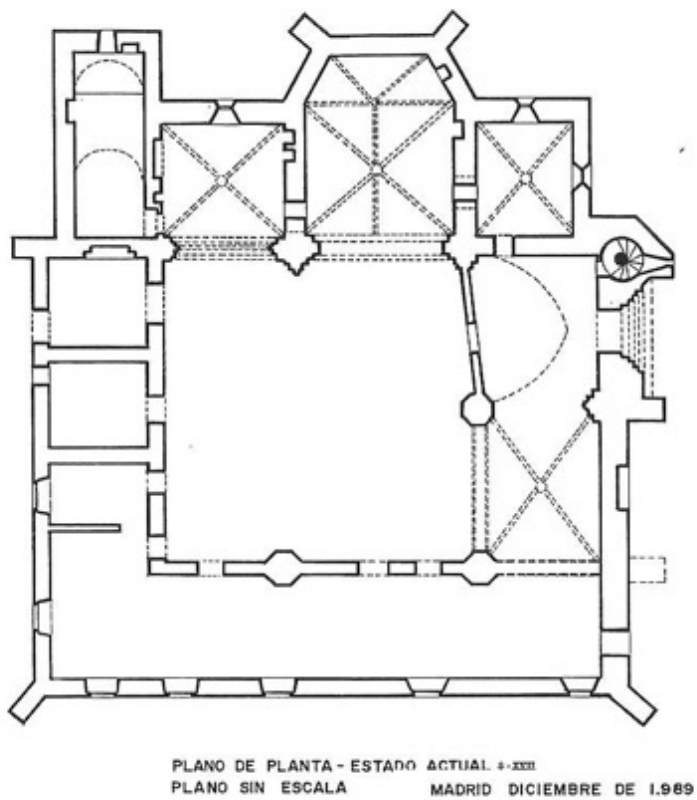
Bonaval, Santa María, Grundriss, Francisco Serrano Jurado, 1989.
